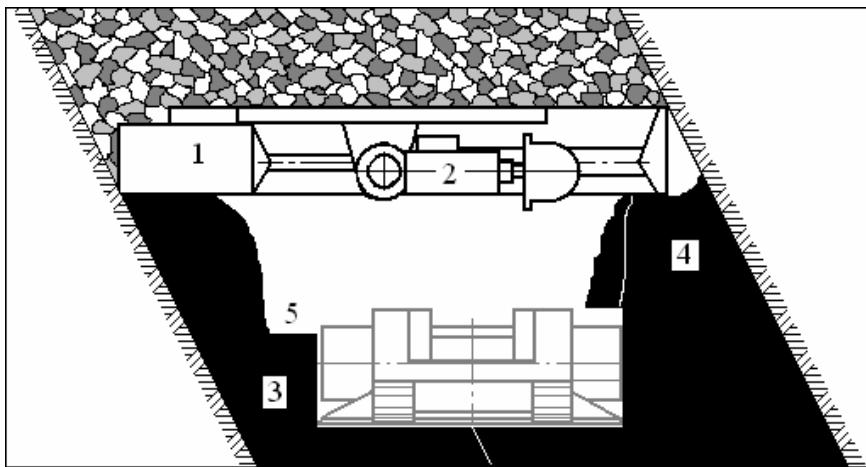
Положение раздвижного щитового перекрытия в зоне вынутого первого слоя: 1 — секция перекрытия; 2 — стреловидный исполнительный орган секции; 3 — целик у почвы пласта; 4 — целик у кровли пласта; 5 — опережающая канава монтажного слоя
